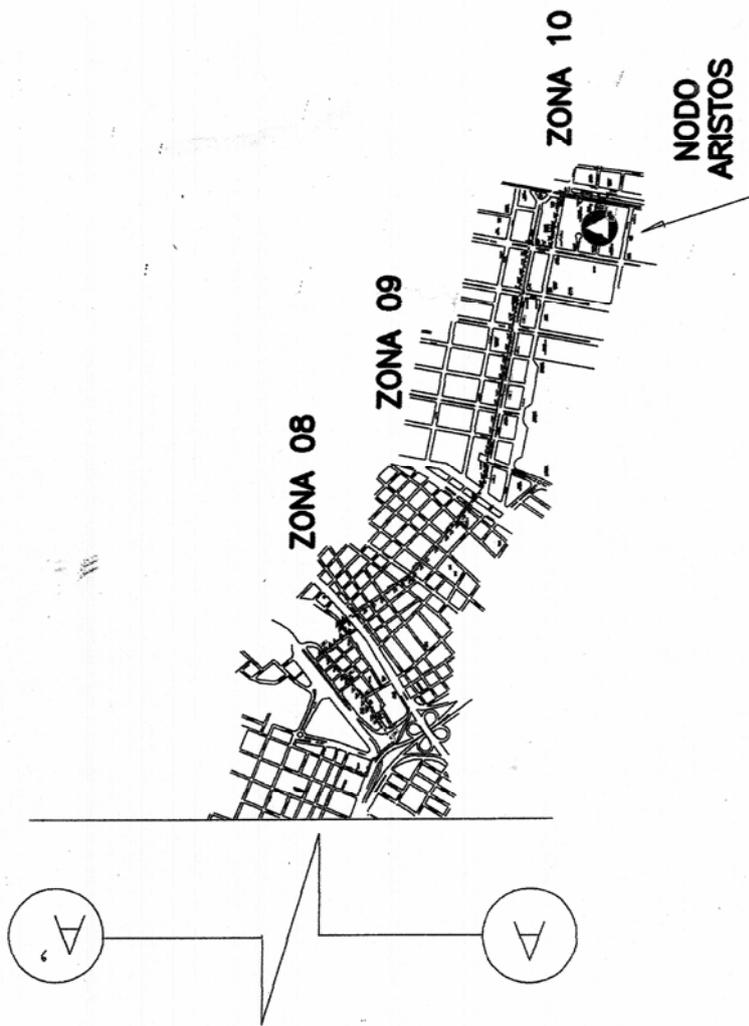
Plano enlace Aristos - El Cortijo zona 12 (Parte II)
